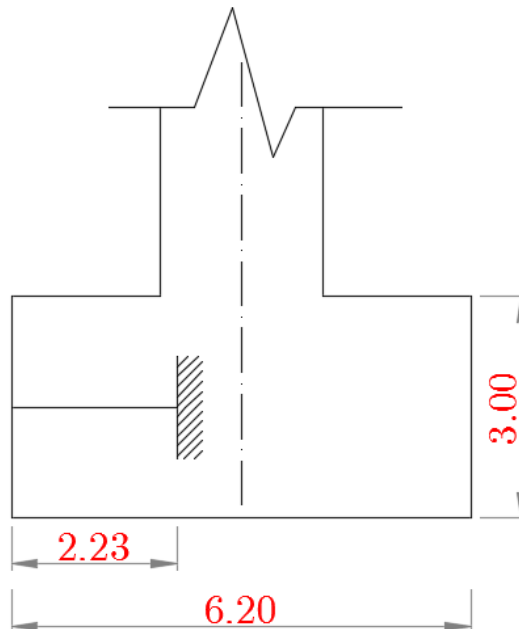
Modelo de cálculo para dimensionamento das armaduras na face superior das sapatas
